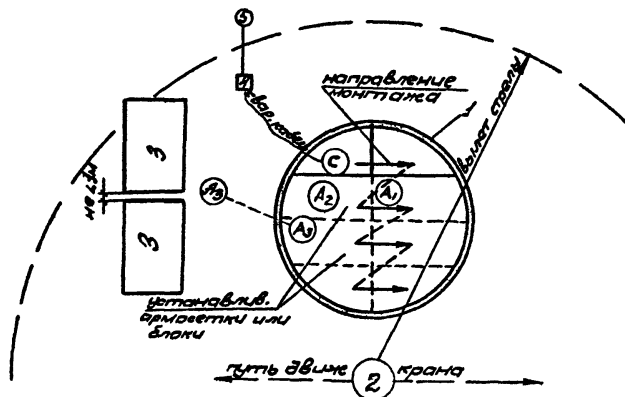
Схема организации рабочего места при укладке армосеток или армоблоков
